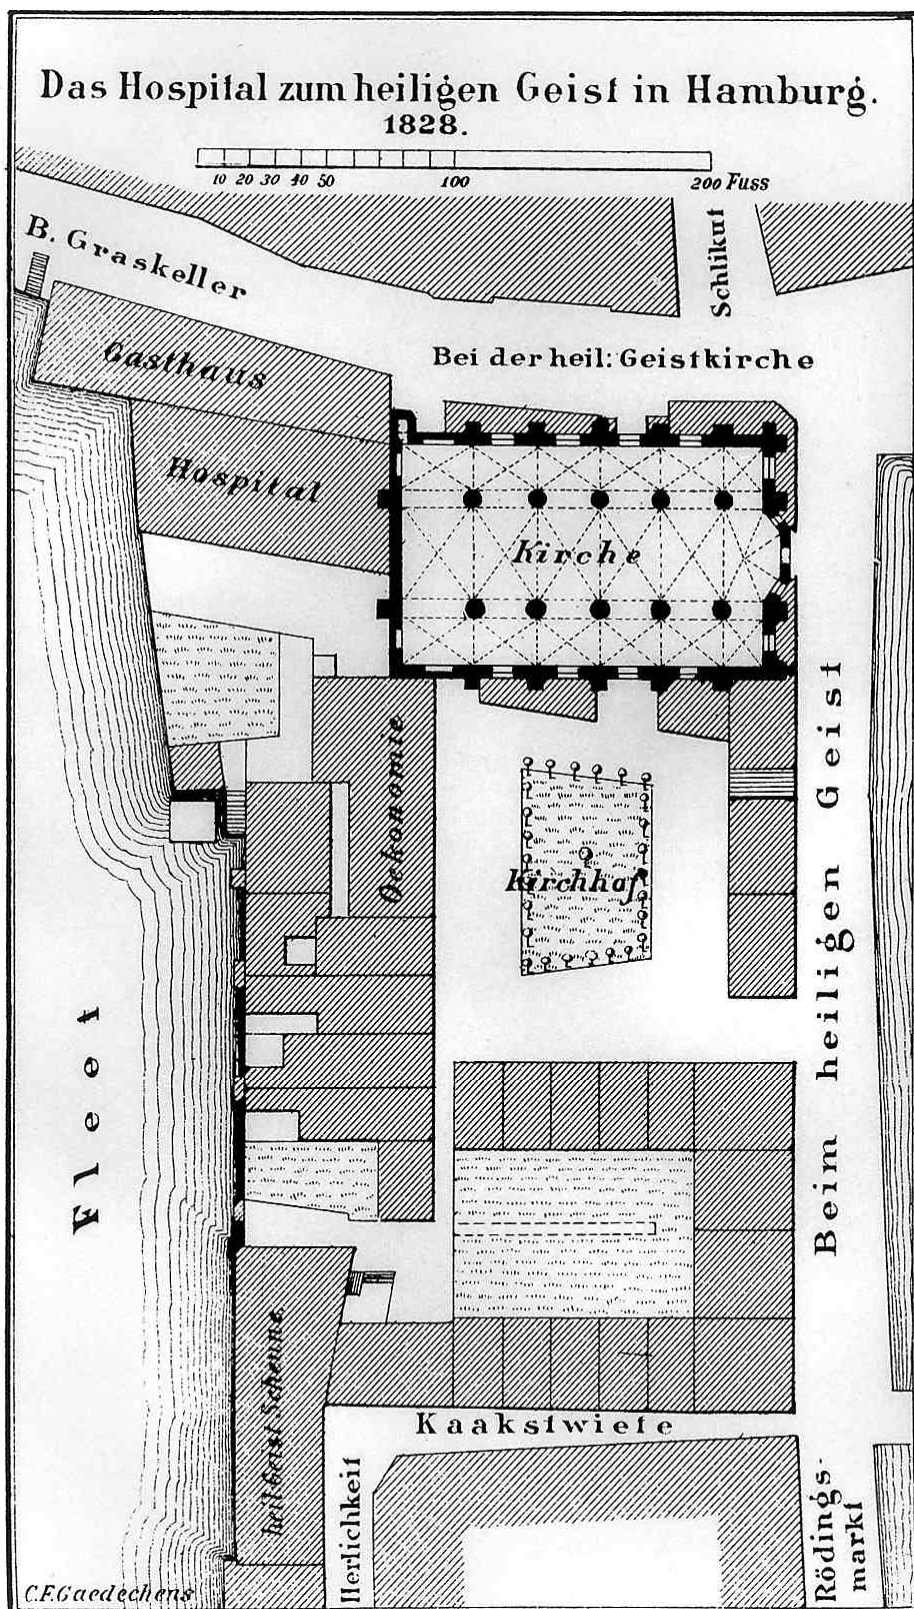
Heiliggeist-Hospital, Hamburg, Grundriss
